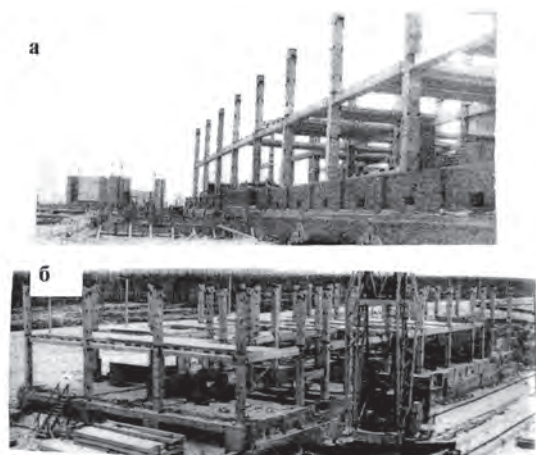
Цоколь каркасного здания (а):1 – складка фундамента; 2 – продух в забирке проветриваемого подполья; Общий вид здания (б).
